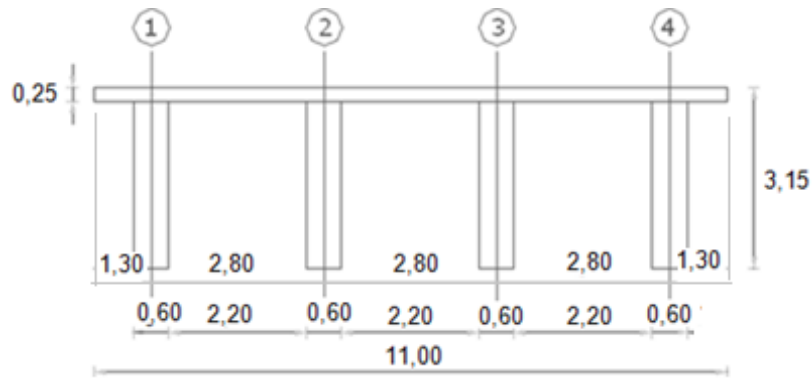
Sección transversal del puente en hormigón armado (alternativa "A")
